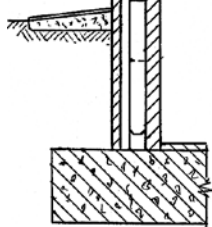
Поперечное сечение наружной стены по цокольной панели и панелям 1-го и 2-го этажей
